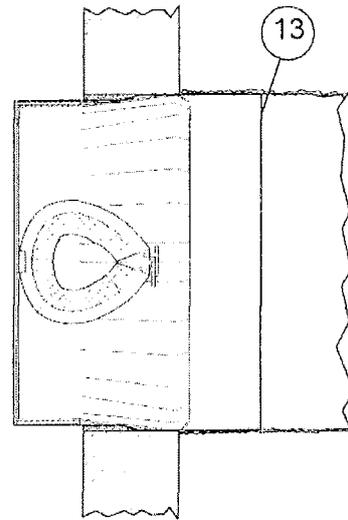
Einbau mit Mauerrahmen und angeschlossener Rohrleitung
